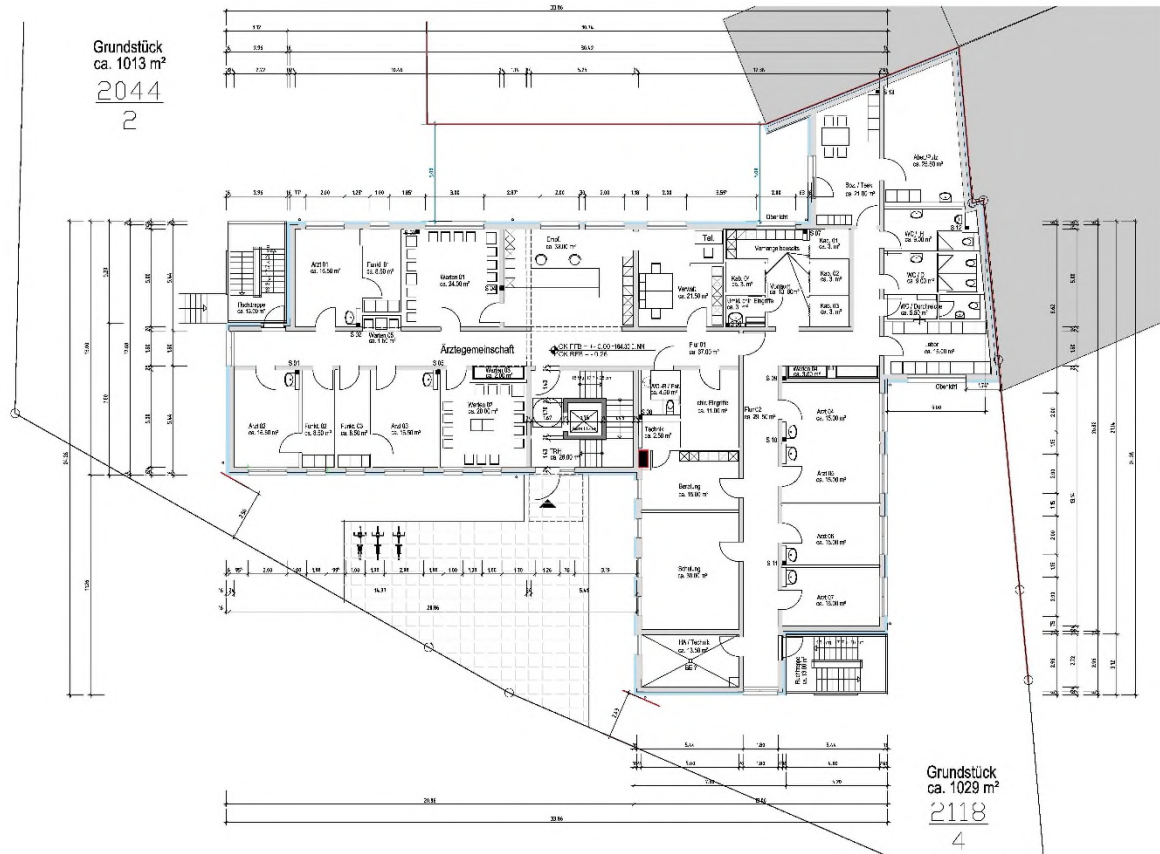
Entwurf Grundriss EG, Quelle Vorhabenträger
